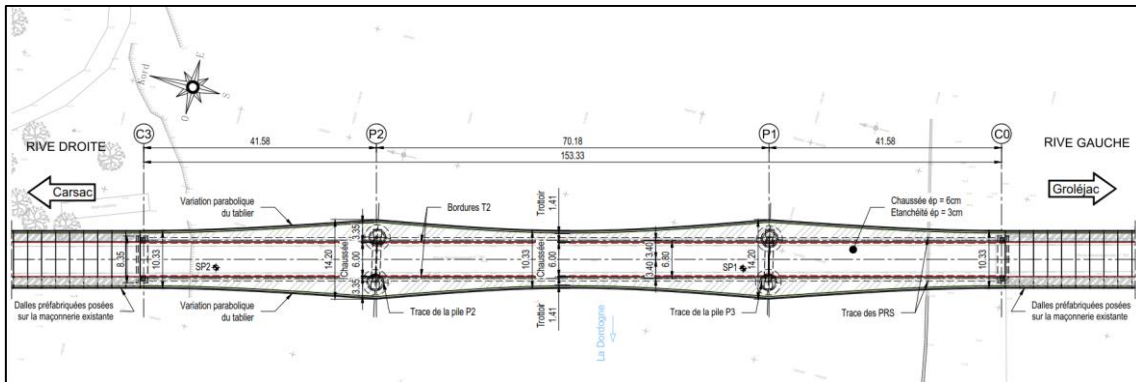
Vue en plan de l'ouvrage définitif (Source : Arcadis)
